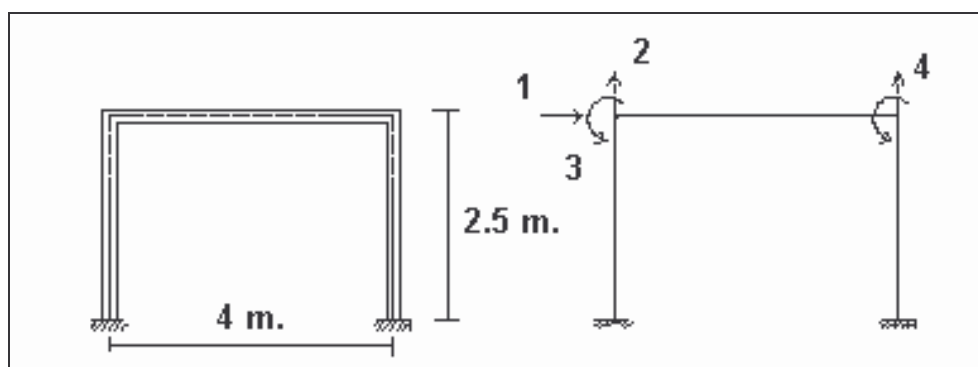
Geometría y grados de libertad de pórtico plano, utilizado en ejemplo 3.
